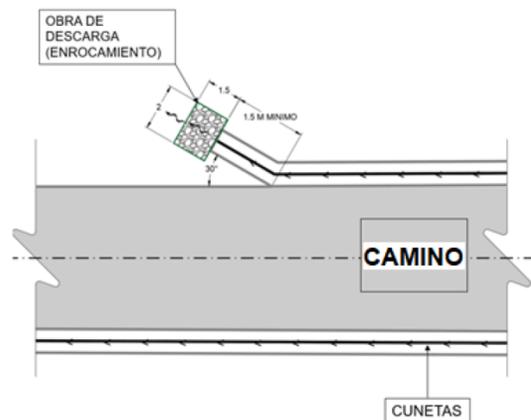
Esquema tipo de cunetas y las obras de descarga
